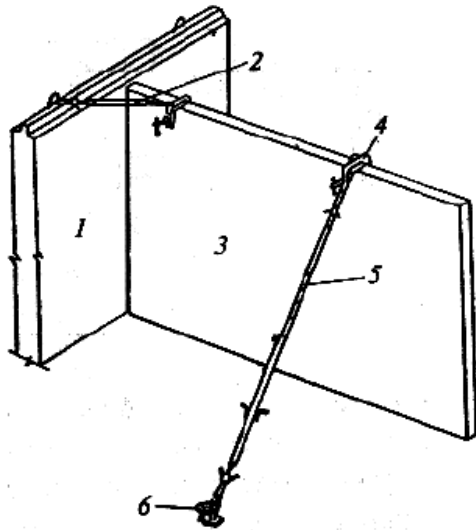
Схема временного крепления панели внутренней стены с помощью монтажной связи и подкоса с инвентарной петлей:
